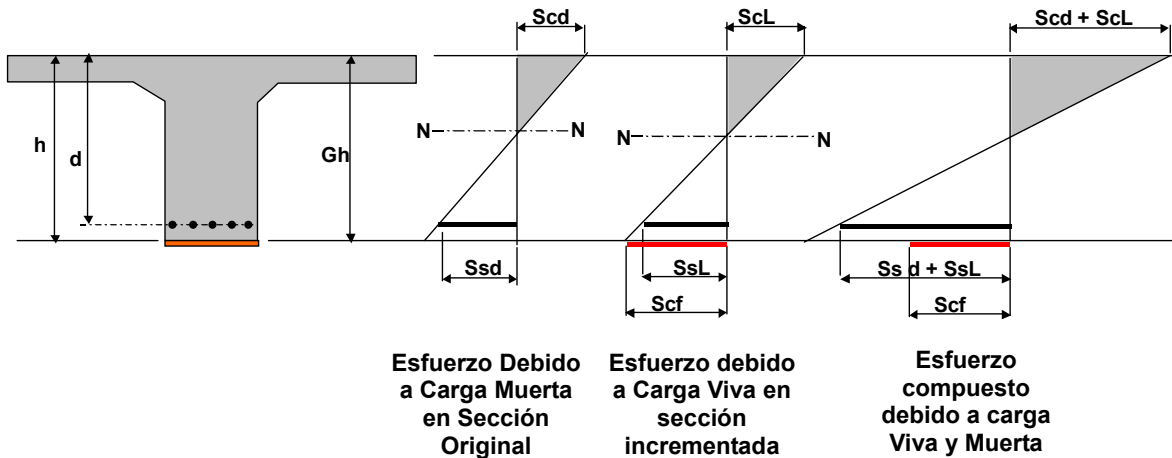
Esfuerzo en refuerzo de viga de RC con Adherencia de FRP
